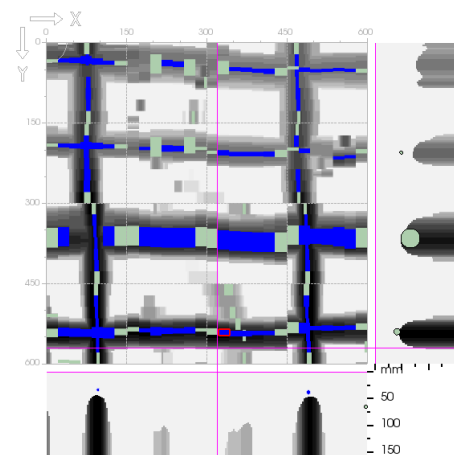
Poutre Pt04 – Travée 2 à mi-travée
